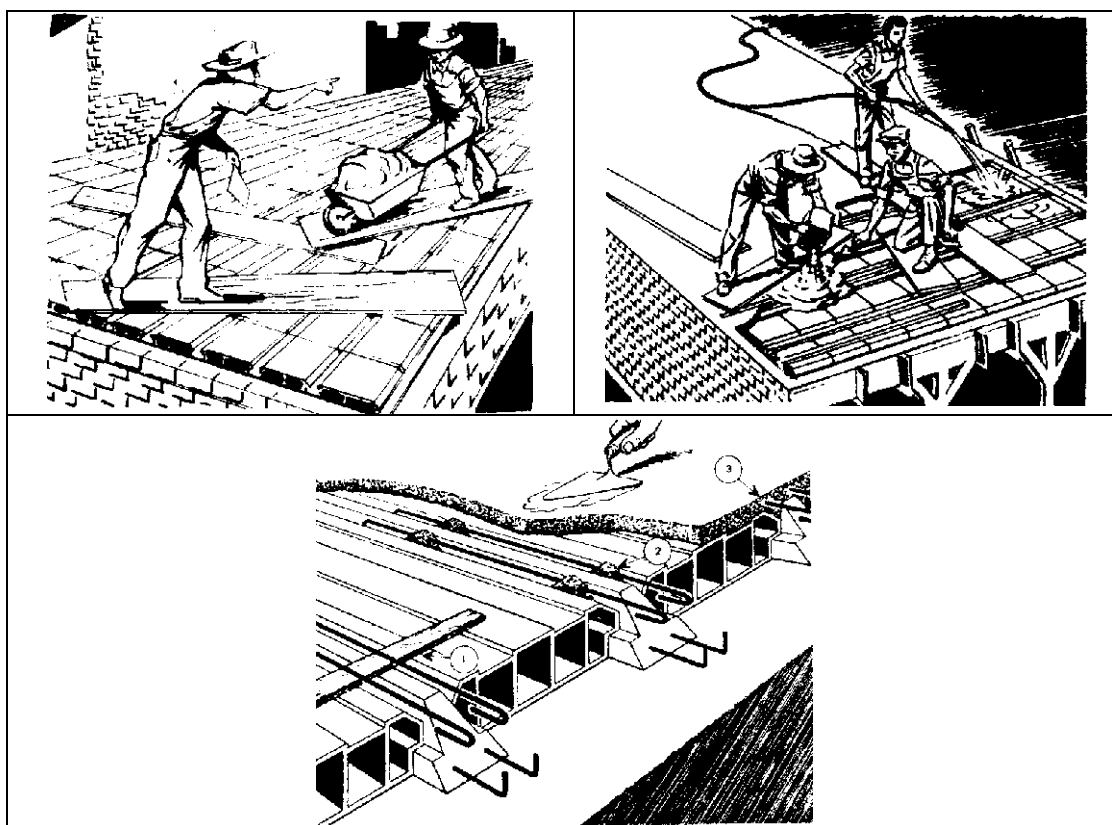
Concretagem da laje (LAJES VOLTERRANA).
